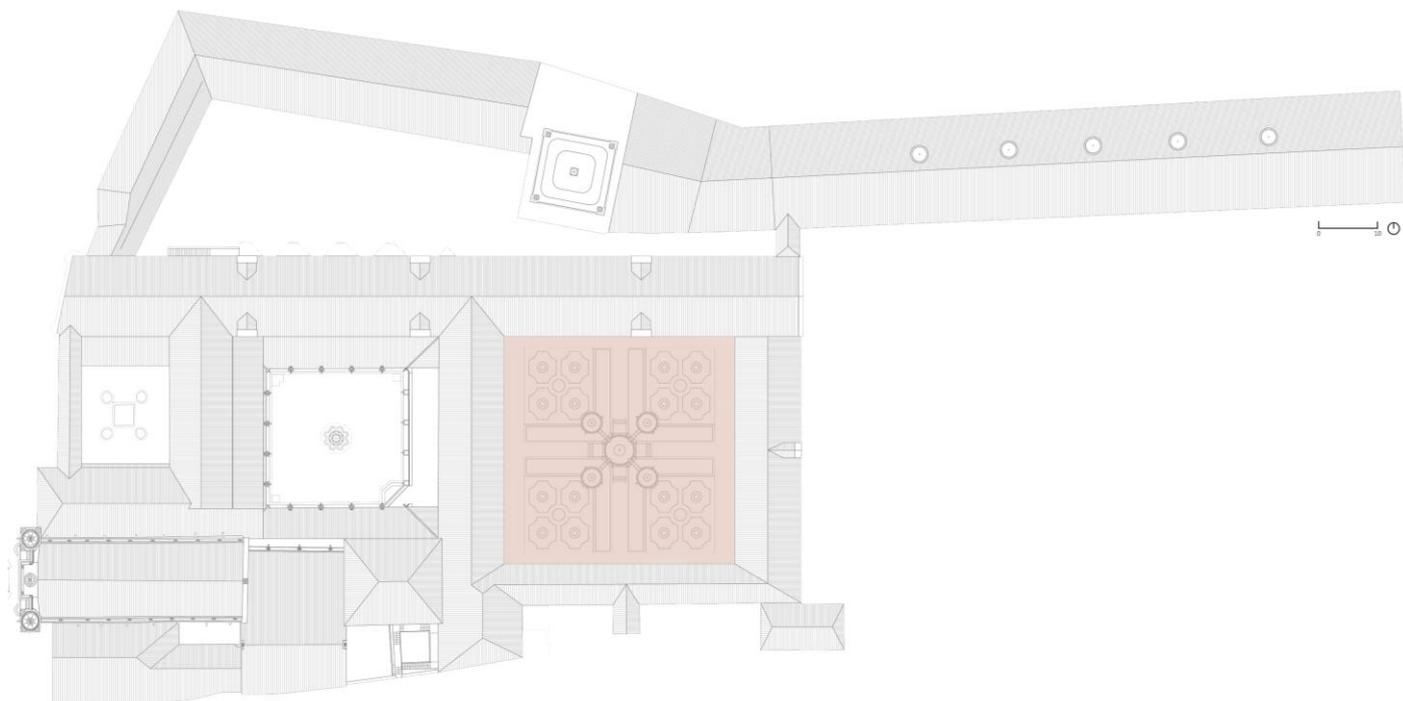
Planta reconstrutiva do Mosteiro de Santa Cruz, 1834, com identificação do Claustro da Fonte da Manga
